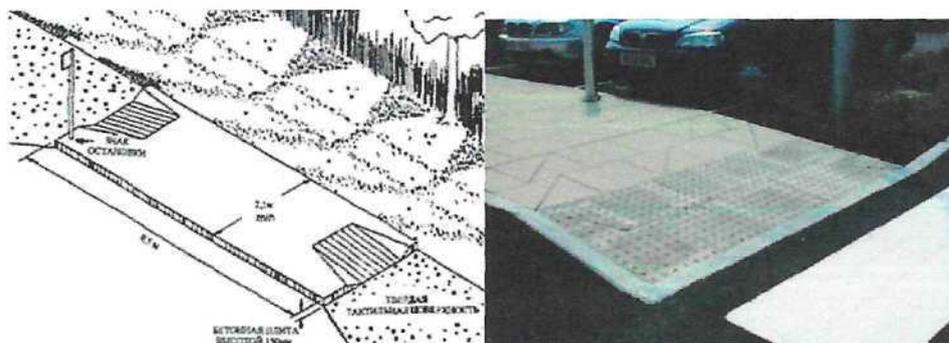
Пример оборудования посадочной площадки пандусами
